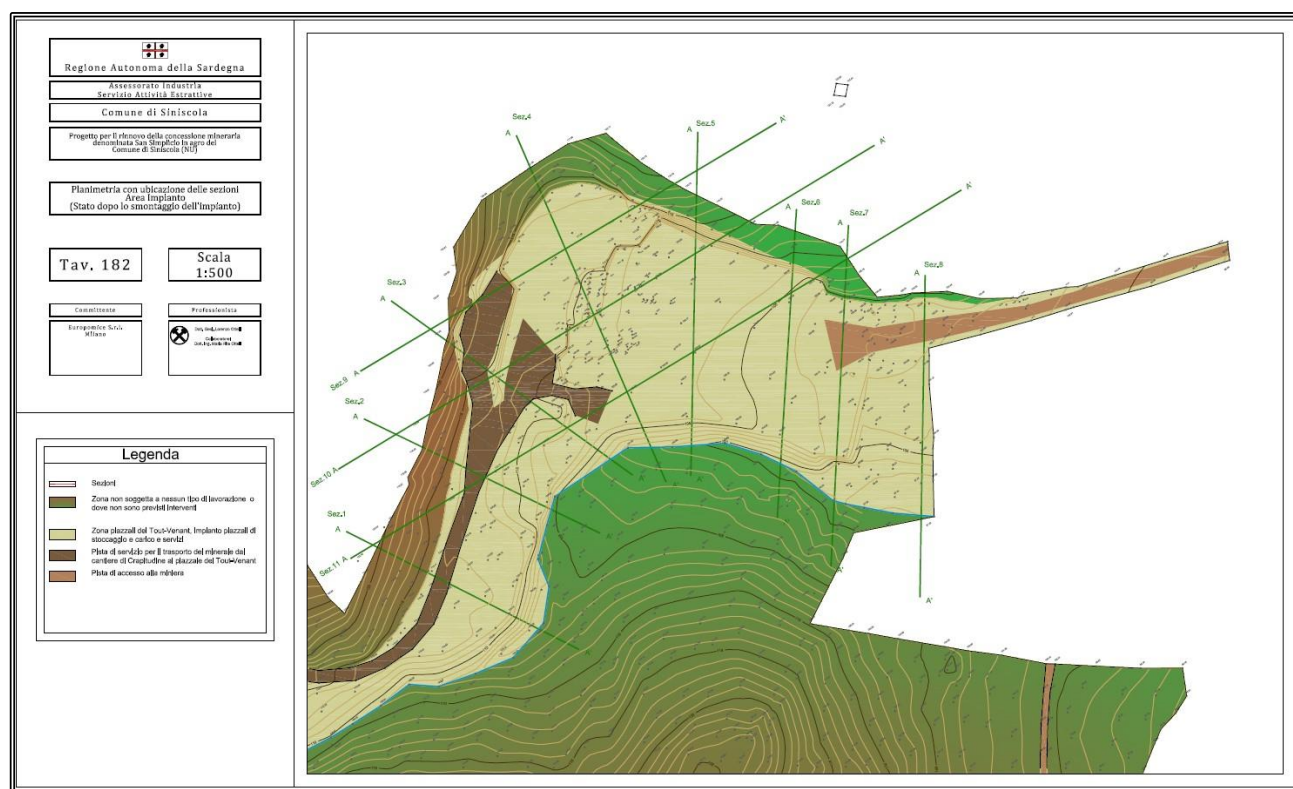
Planimetria dell'area dell'Impianto così come dopo lo smantaggio dell'impianto.
